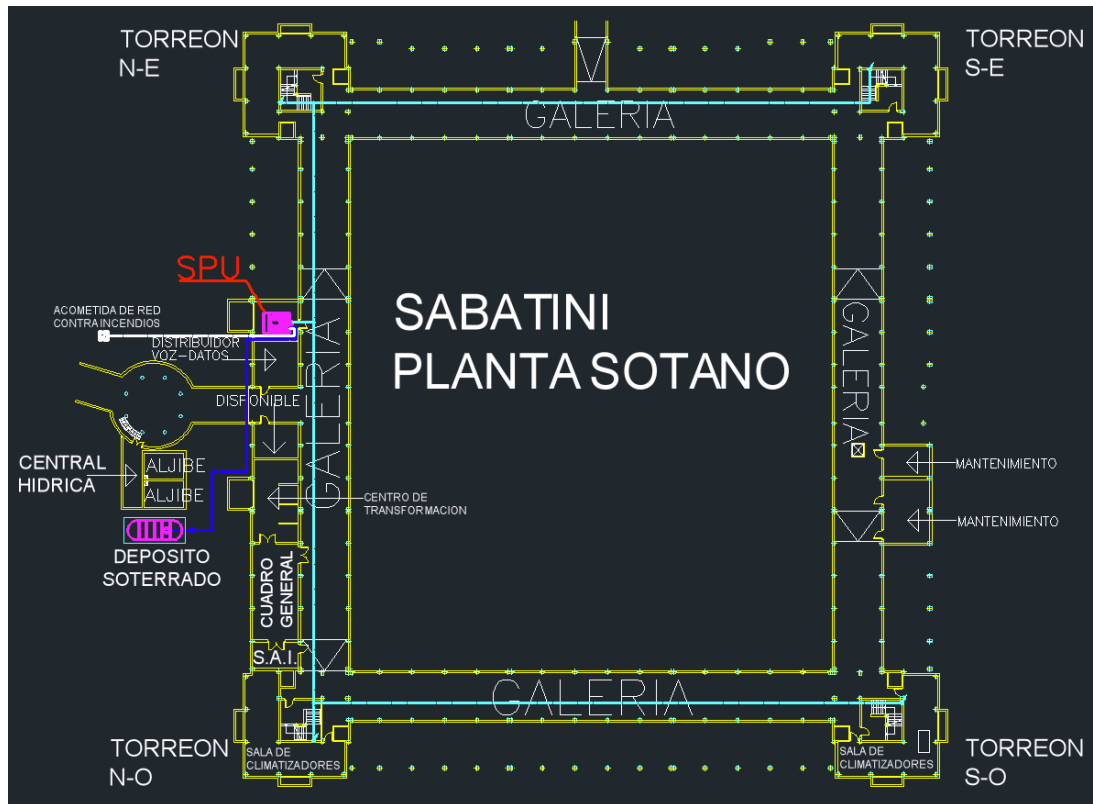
Vista en planta del sótano con la distribución del sistema - AutoCAD
